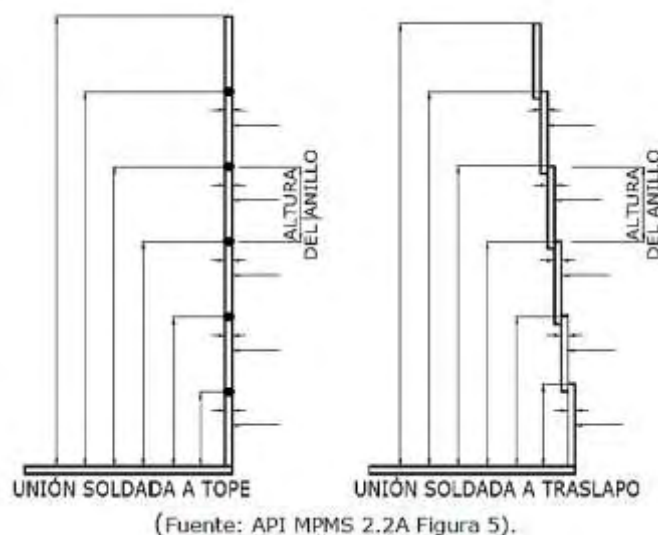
Posiciones para la medición de circunferencias en tanques soldados. [11]
